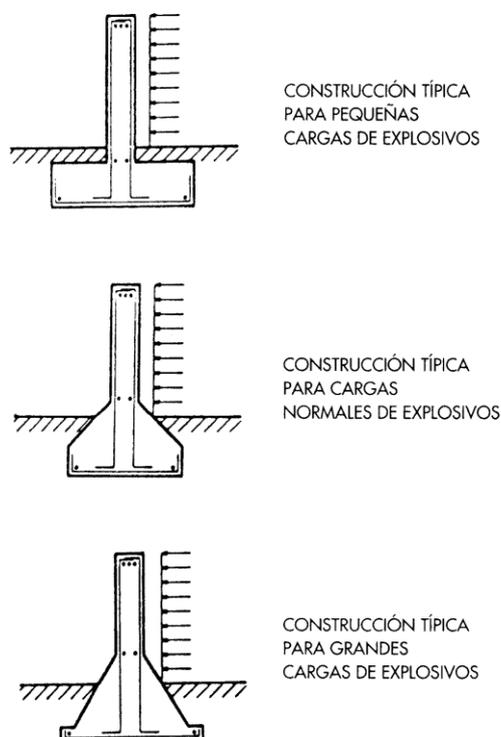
Configuraciones básicas de diseño (hormigón armado)
